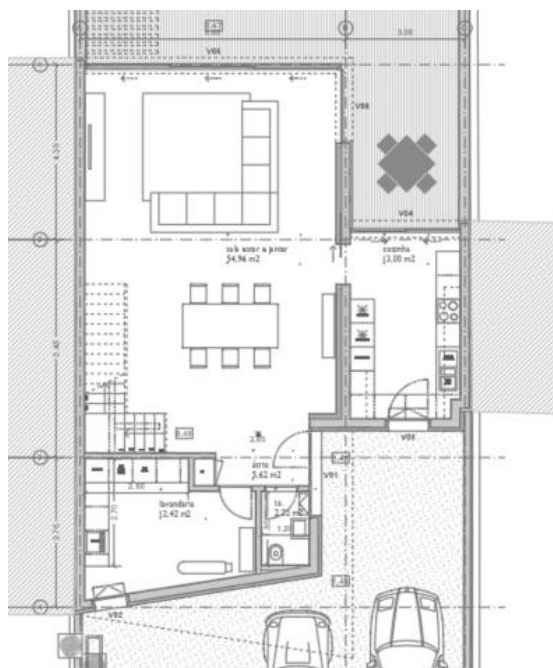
Planta do Piso 0 (Fonte: Blackcurrant)
